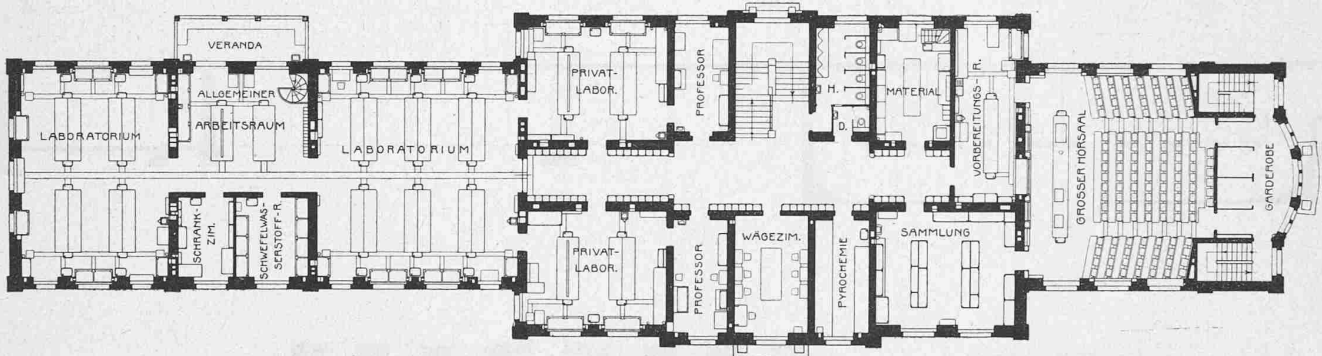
Grundriss vom I. Stock. — Masstab 1 : 400.
